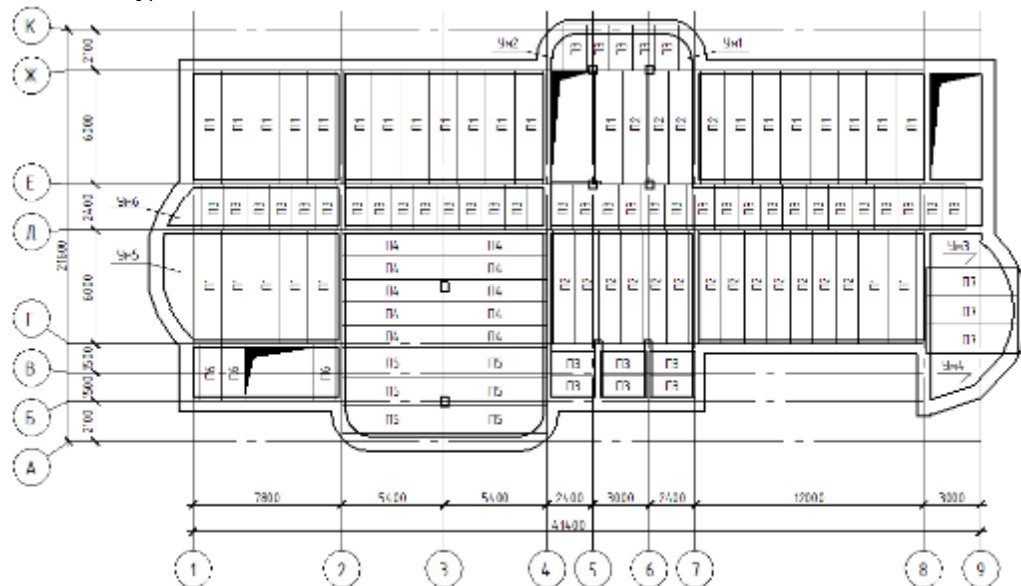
Диск перекриття із збірних залізобетонних багатопорожнистих плит
